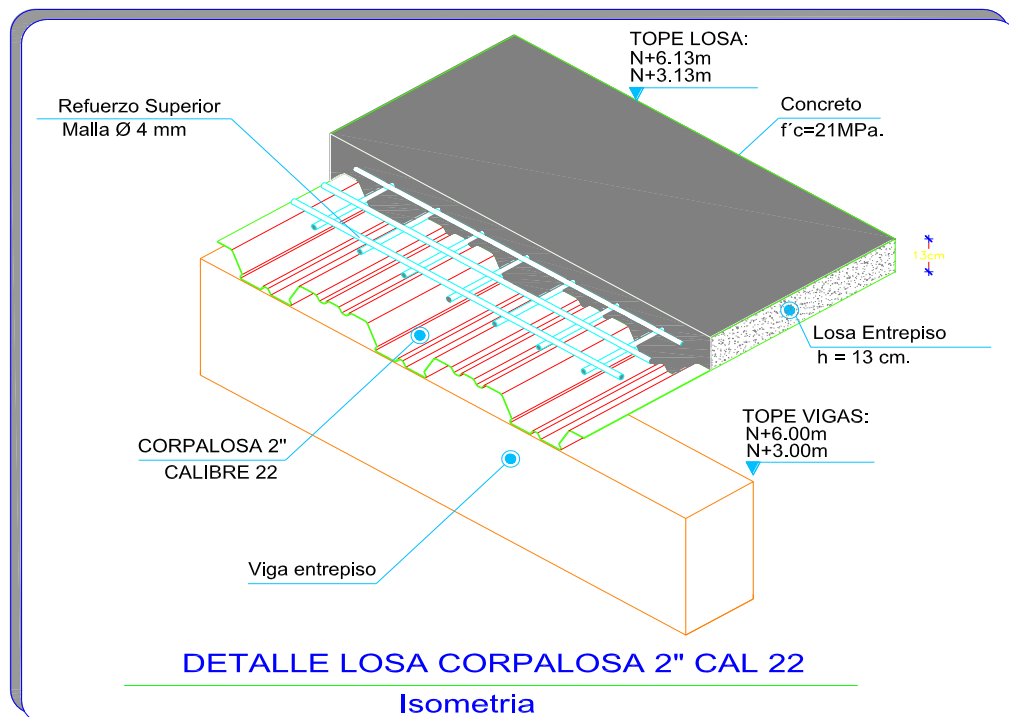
DETALLE DE LOSA ALIGERADA EN METALDECK.
